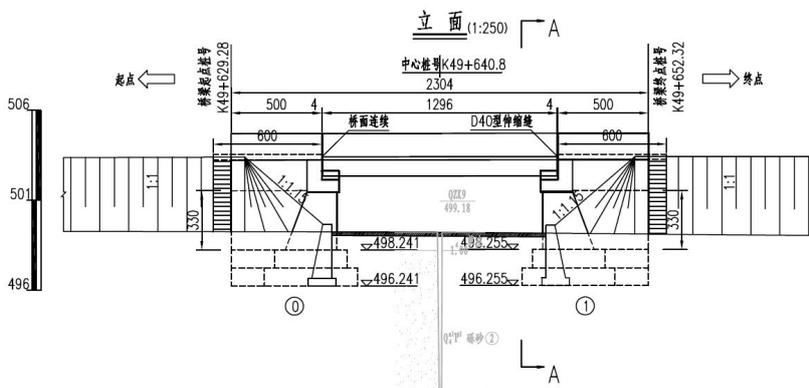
小桥设计立面示意图 (K49+640.8)
